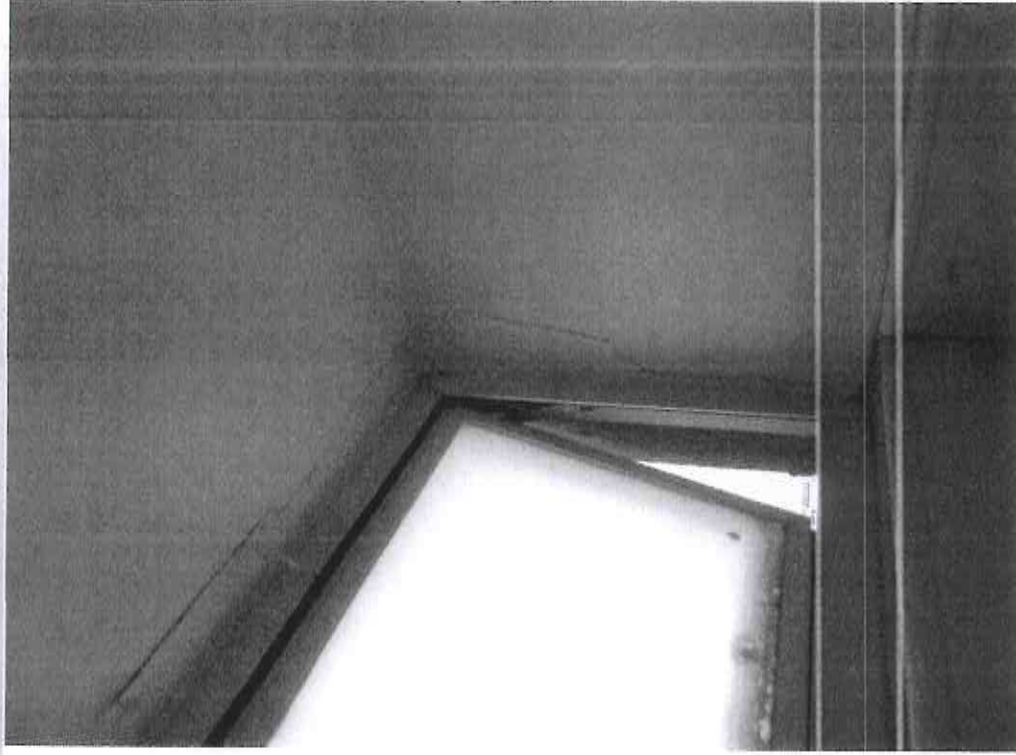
Nivel 4, Fisuras en capa de compresión, dichas fisuras, se encuentran ya registradas por un estudio previo de la UNAM.
